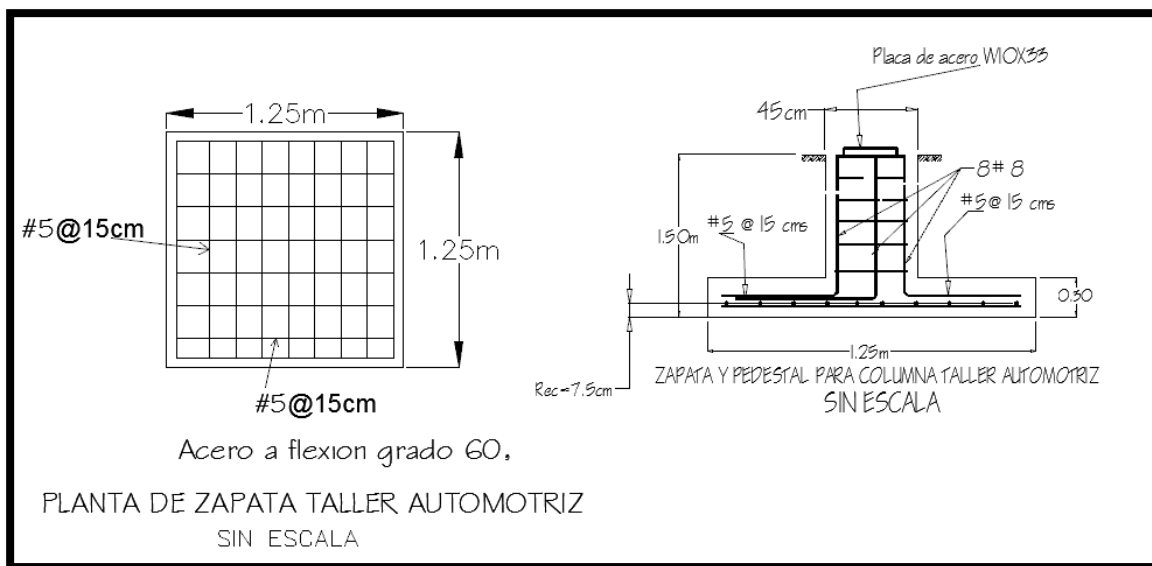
Sección transversal de la zapata con medidas y distribución de acero
